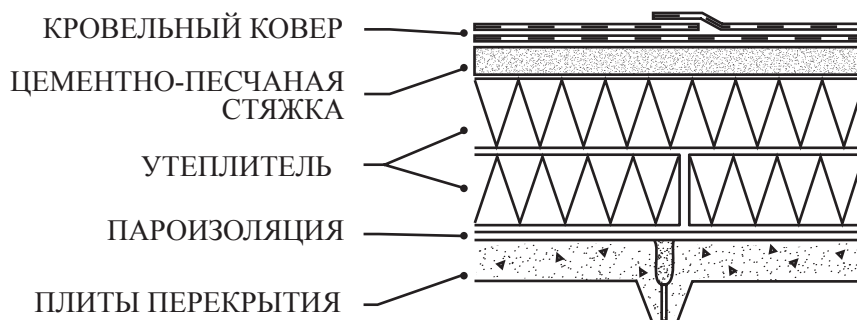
Кровельная система с применением несущих плит или монолитного железобетона.
